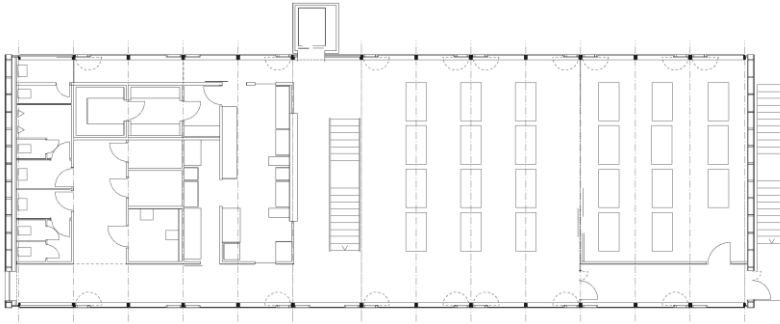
Grundriss Mensagebäude Michaeli Gymnasium
